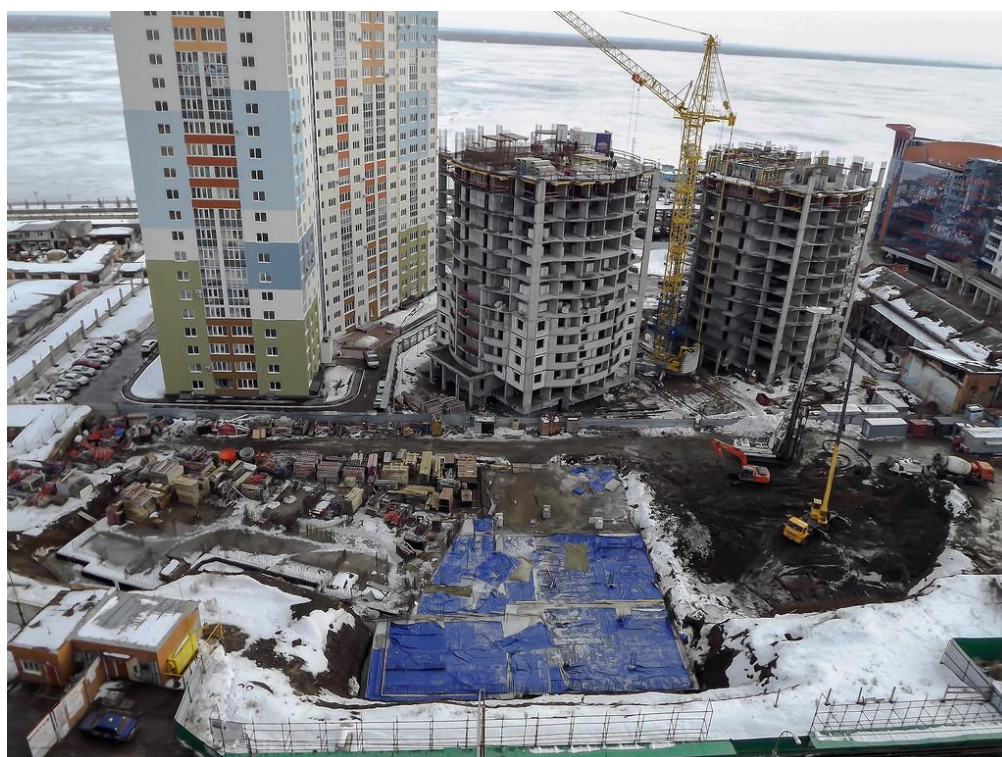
Укрыв плиты перекрытия теплоизоляционным материалом
